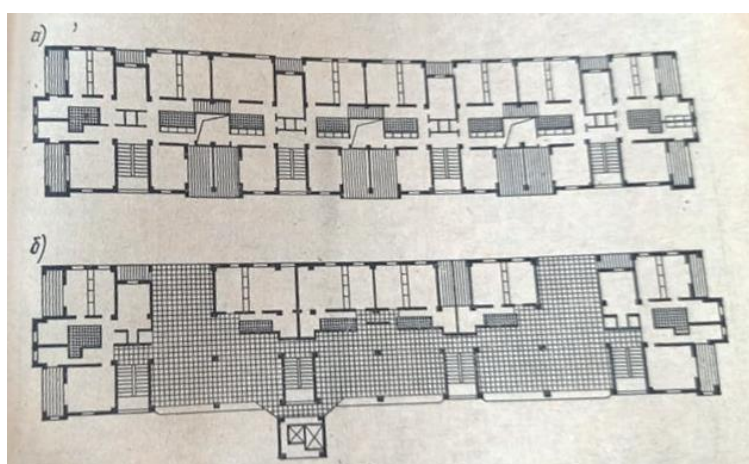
Проект 16-этажного каркасно-панельного жилого здания с внутренними дворами: а – этаж с внутренними дворами; б – этаж с дворами-верандами.
